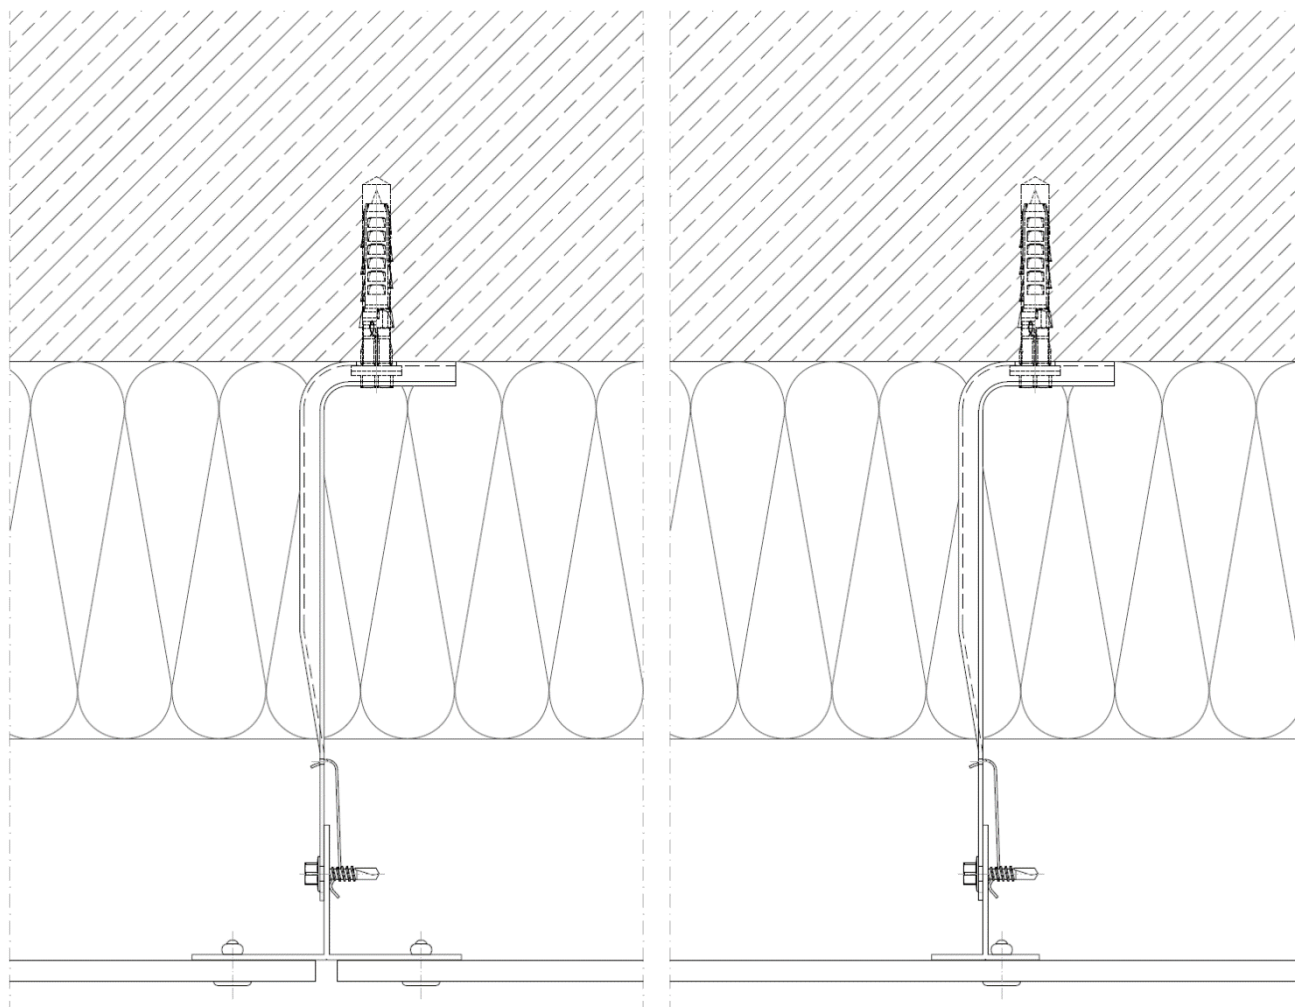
Horizontaler Schnitt mit ATK 100 vertikalen T-Profilen und sichtbar befestigten Fassadenplatten
